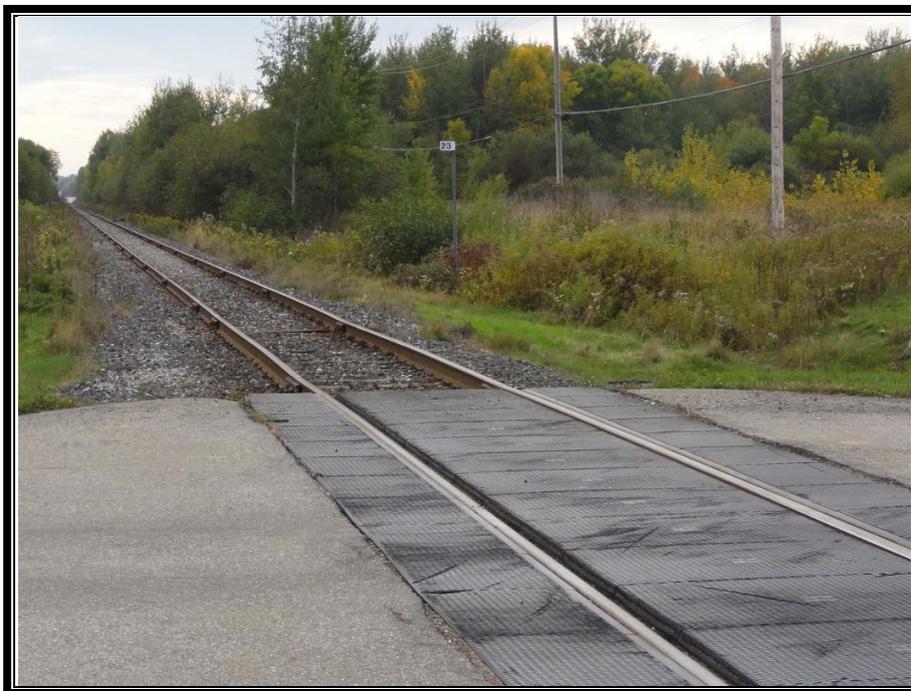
Branche ouest du ruisseau Mayrand au sud de la voie ferrée
